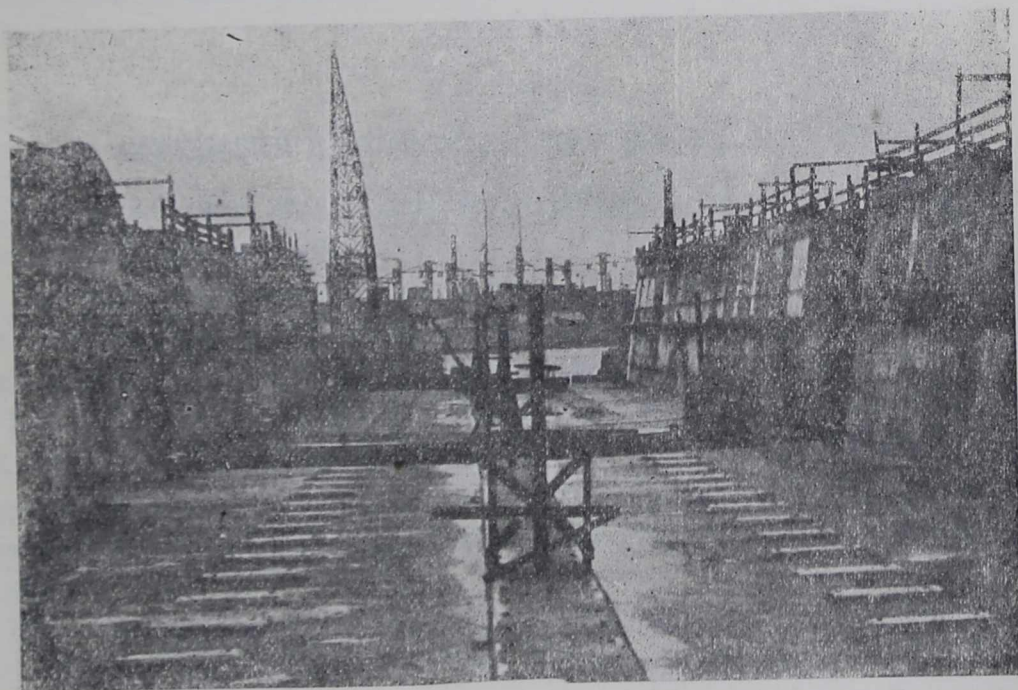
Ремонт железобетоном. Арматура внутренней железобетонной одежды.
